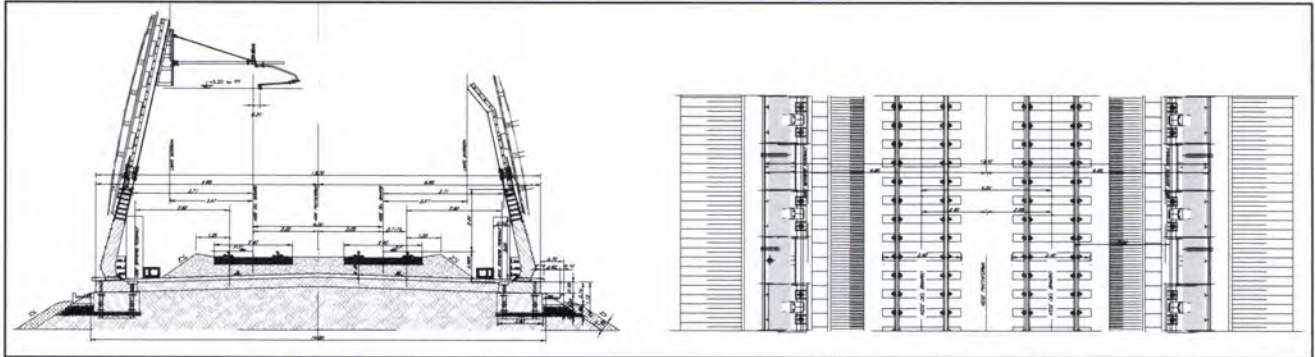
Sezione Tipo doppio binario in Rilevato con Barriere Antirumore.
